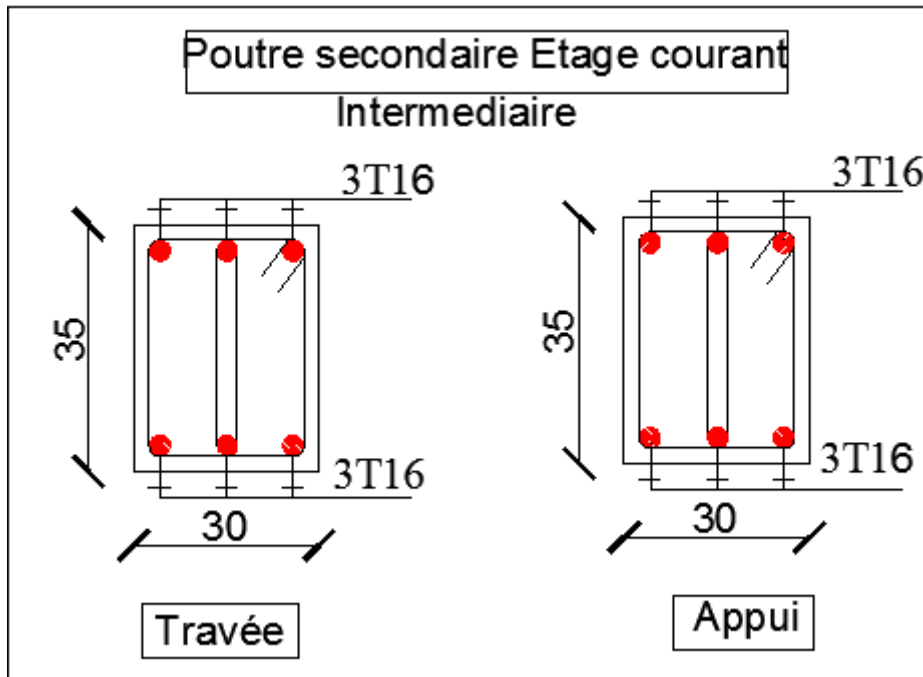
Ferrailage des poutres secondaires intermédiaires des étages.
